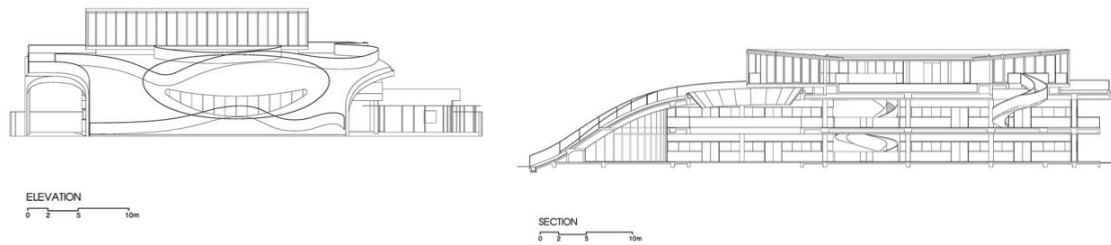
Coupe et façade du projet, Source : ArchDaily
